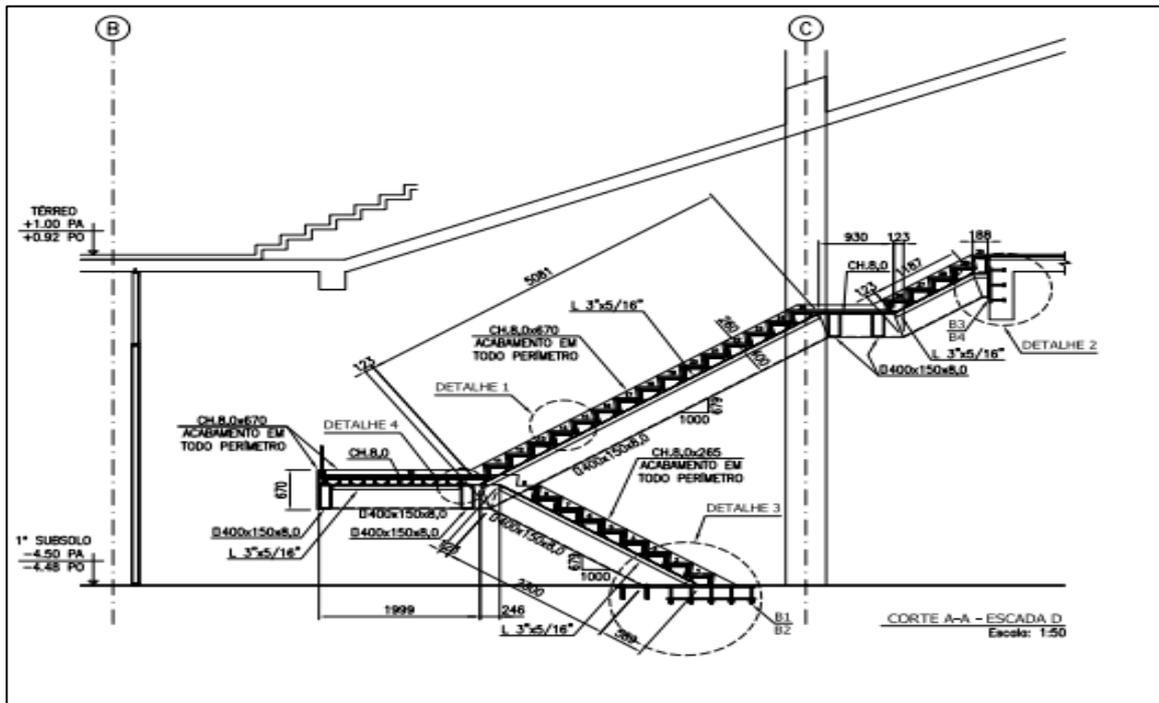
Demonstração da Patologia da Escada em Estrutura metálica – 2º Subsolo
